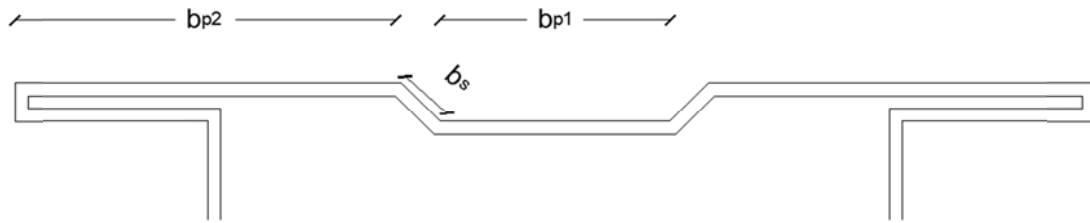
Soluzione di irrigidimento della flangia con 1 bugna
